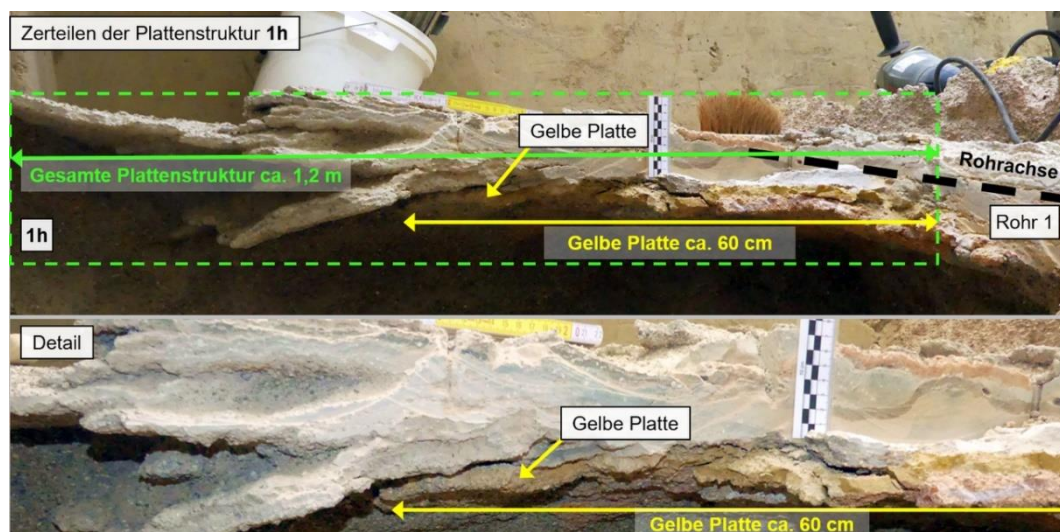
Horizontale Plattenstruktur am Rohr 1: Neue Injektionsrisse folgen bestehenden Strukturen und führen damit zu einer Vergrößerung der Plattenstruktur
